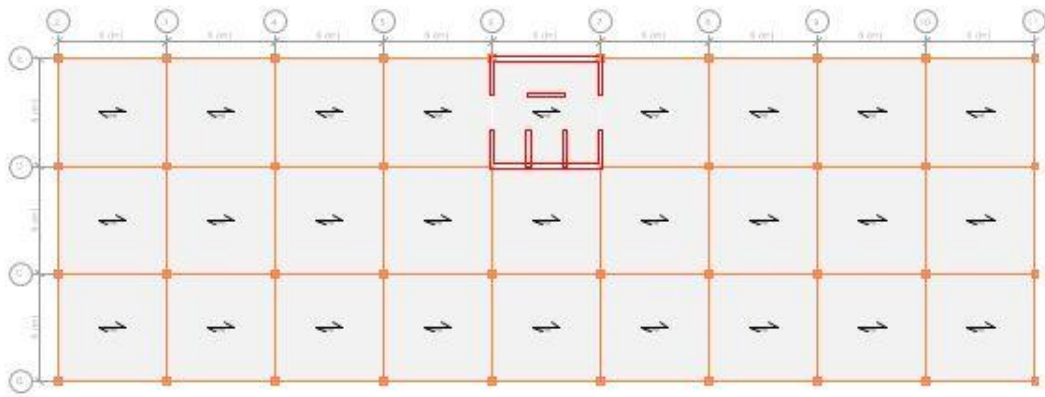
Planta del edificio con simetría,  $CA=CR$ .
